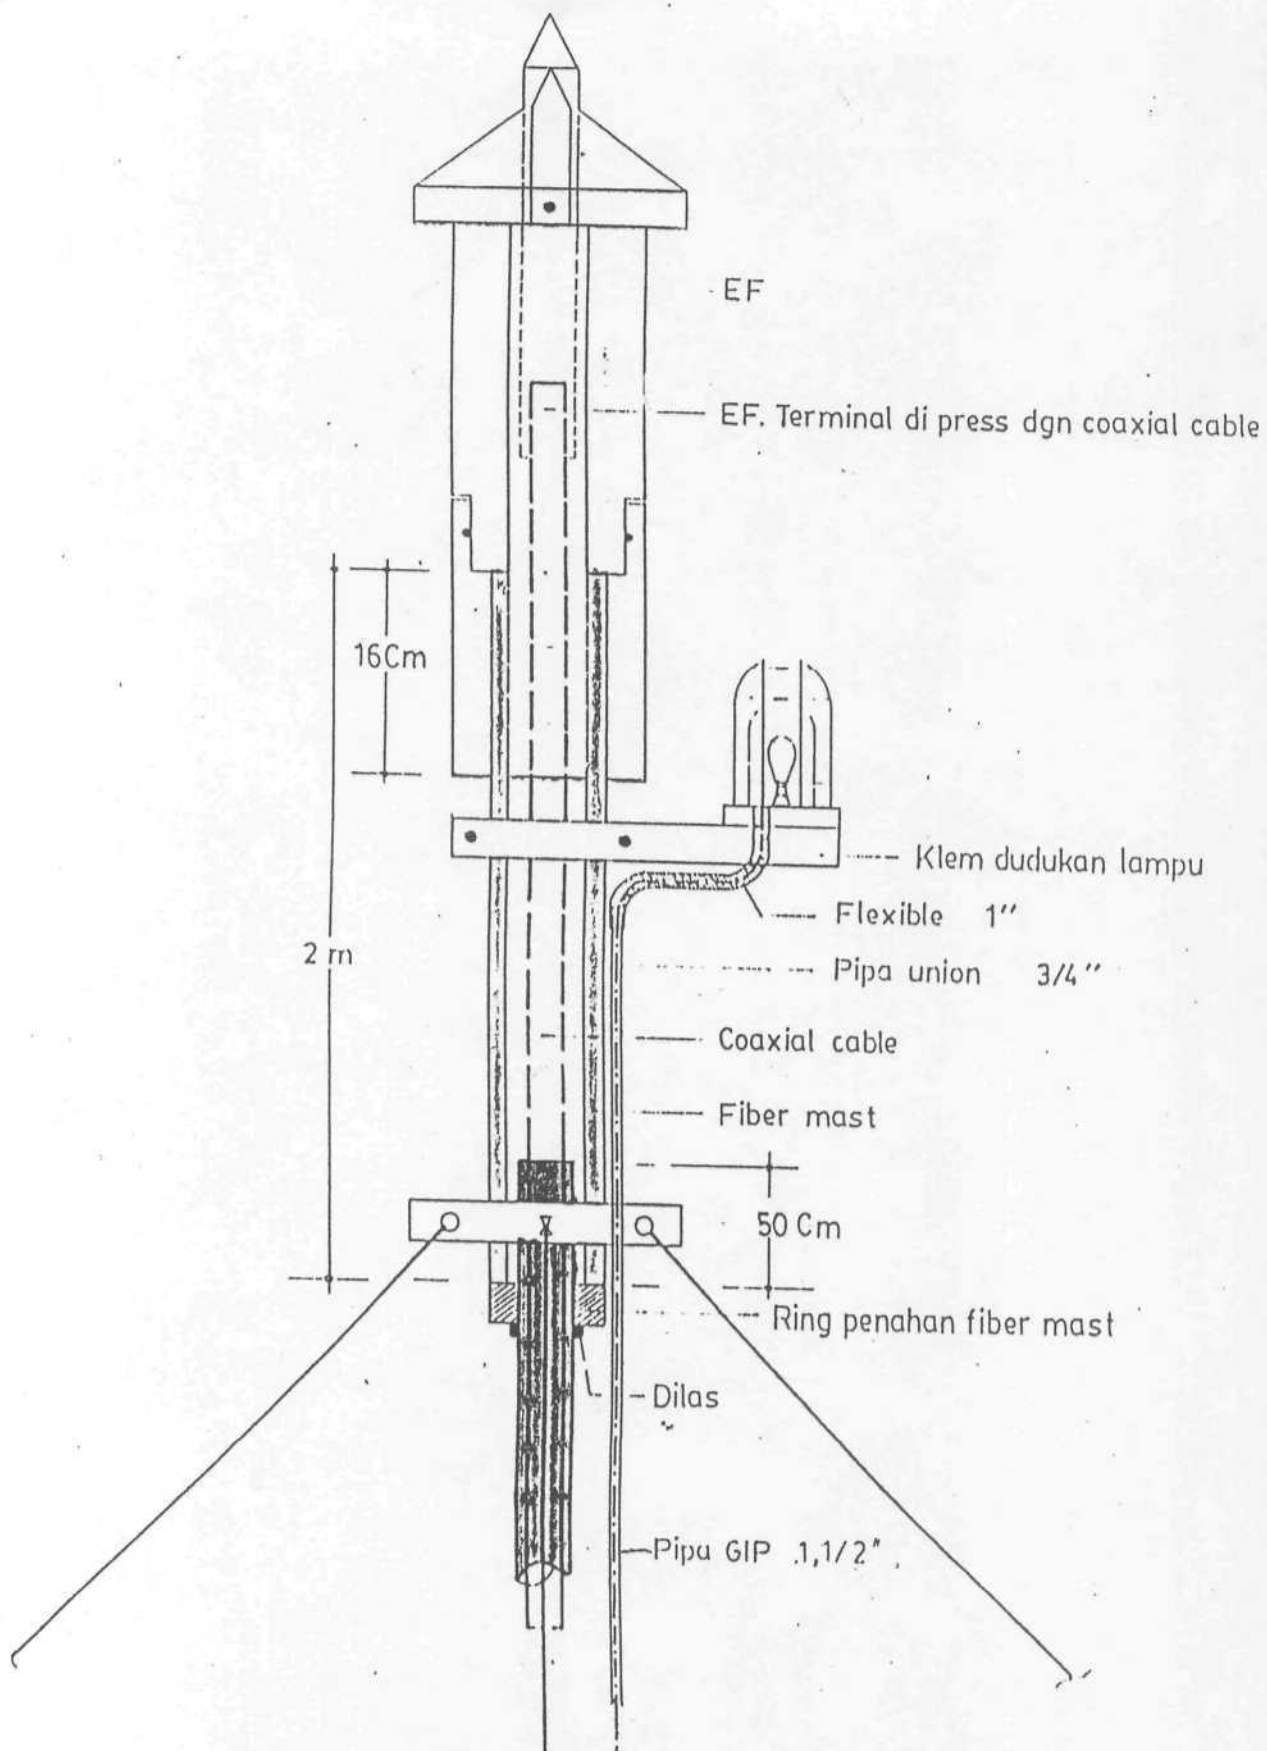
Detail 1 Instalasi Penangkal Petir Gedung W
